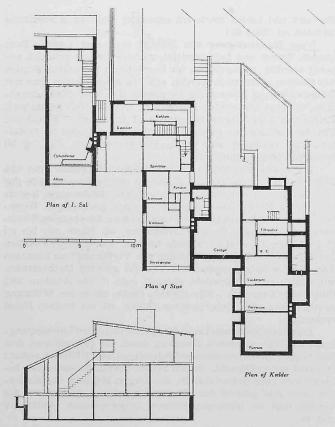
Reihenhaus in Soholm, Grundriss und Schnitt, 1:1000.
